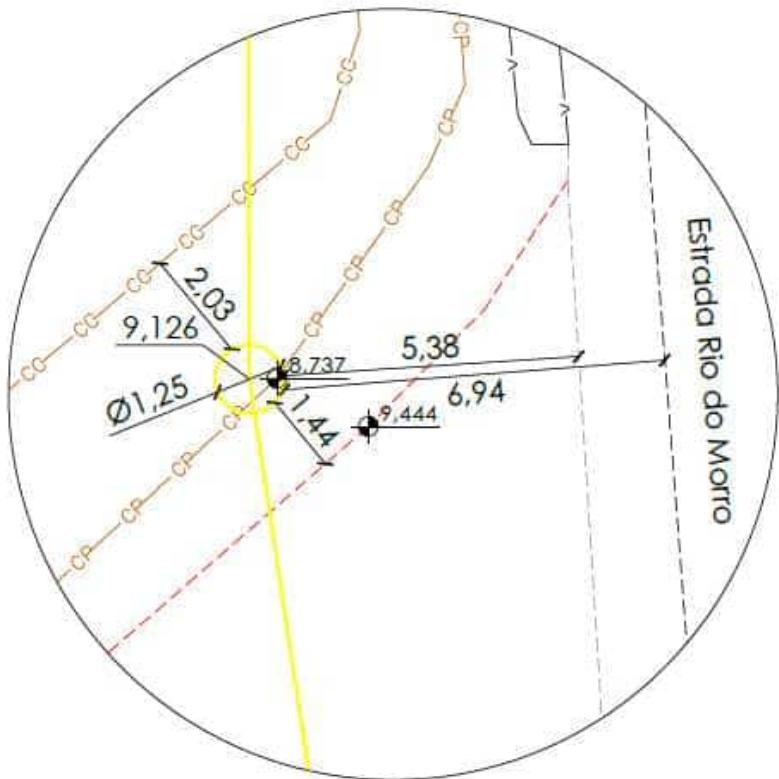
Recortes das plantas de implantação dos postes. Escala: 1/100.
